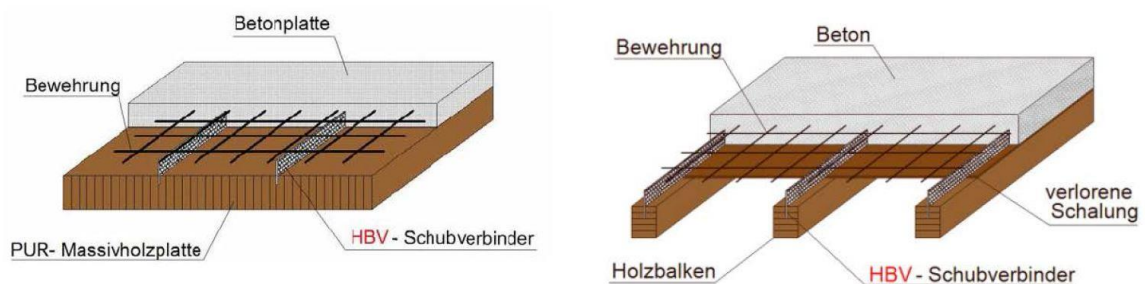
HBV-Decke mit HBV-Schubverbinder aus Brettstapel (links) und Holzbalken (rechts) mit Streckmetall-Schubverbinder [67]
